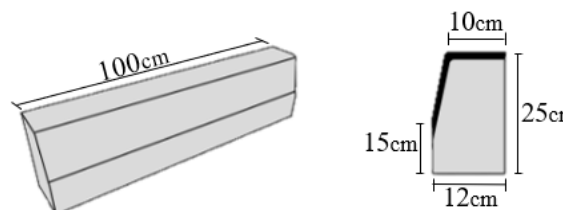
Dimensiones técnicas de un bordillo tipo rebajado de hormigón
